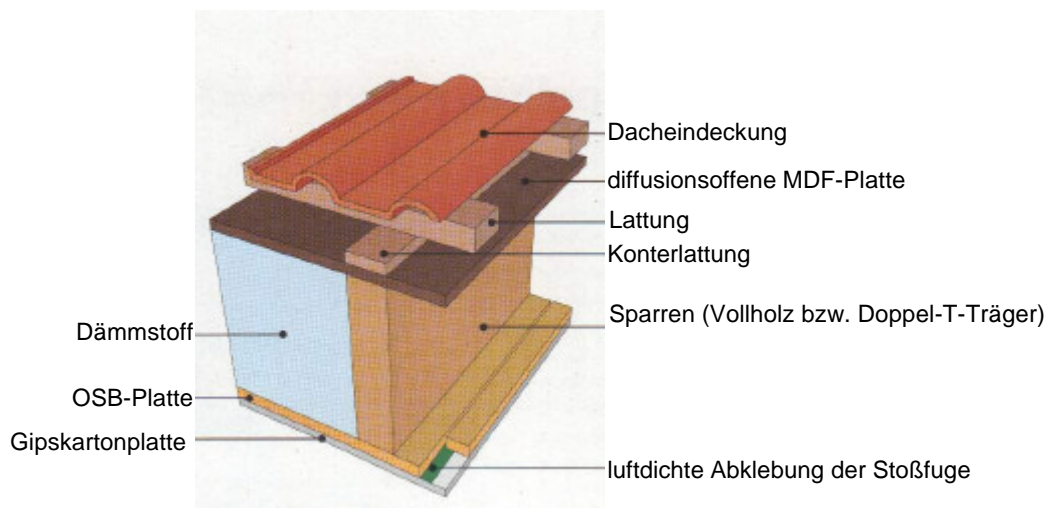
Dachkonstruktion mit neuen Holzwerkstoffen (JOCHER 1997)
